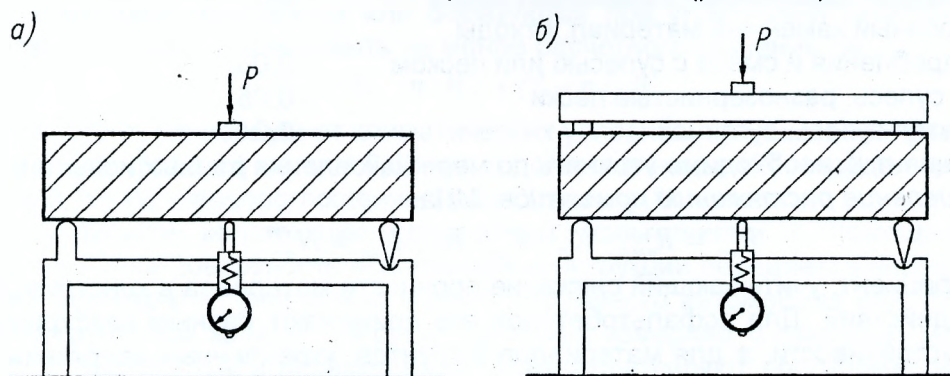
Схемы для учета смятия балочки на опорах при испытаниях ее на изгиб: а – для общего вертикального перемещения середины балочки; б – для вертикального перемещения от смятия балочки на опорах
